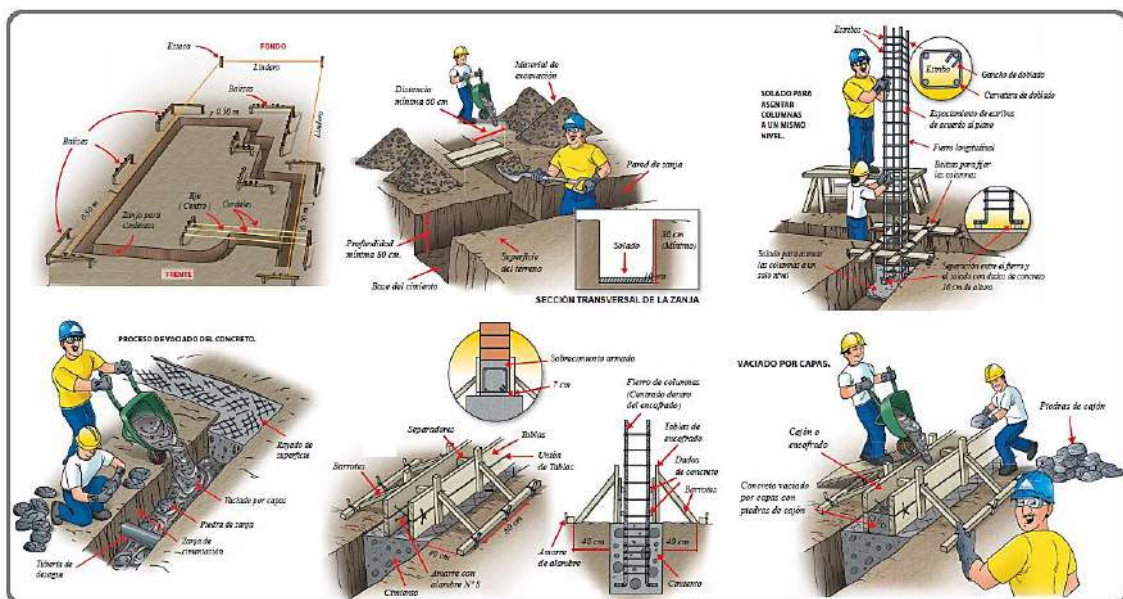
Consideraciones al construir una cimentación para una vivienda de albañilería.
